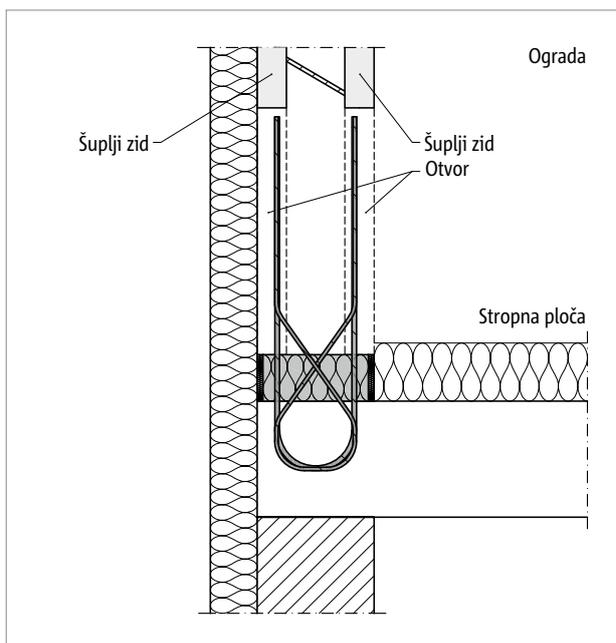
Schöck Isokorb® XT/T tip AP vertikalna ugradnja: Priključak parapeta na ploči
